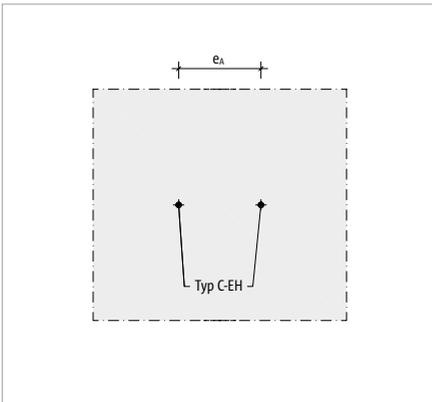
Schöck Isolink® Typ C-EH: Achsabstand
